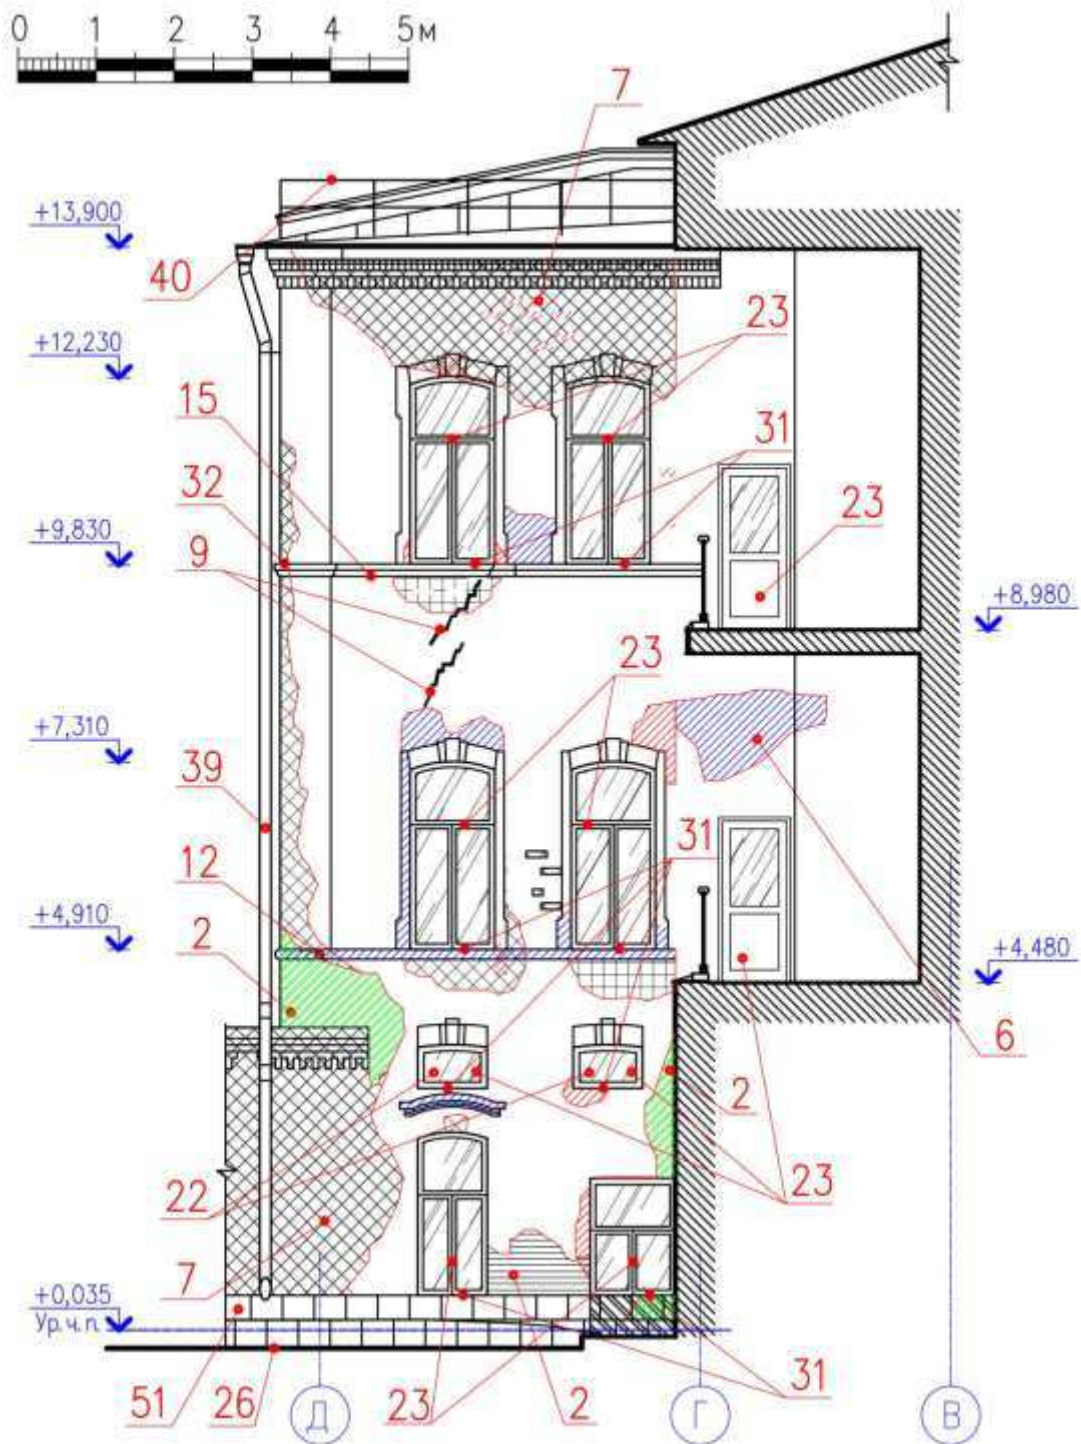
План реконструкции дома Вильнера фасад в осях Д-В
